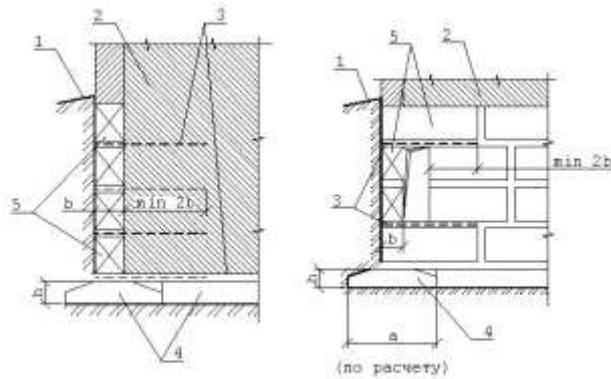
Примыкание кирпичной стены к стене из бетонных блоков (а) и устройство вводов (б):
